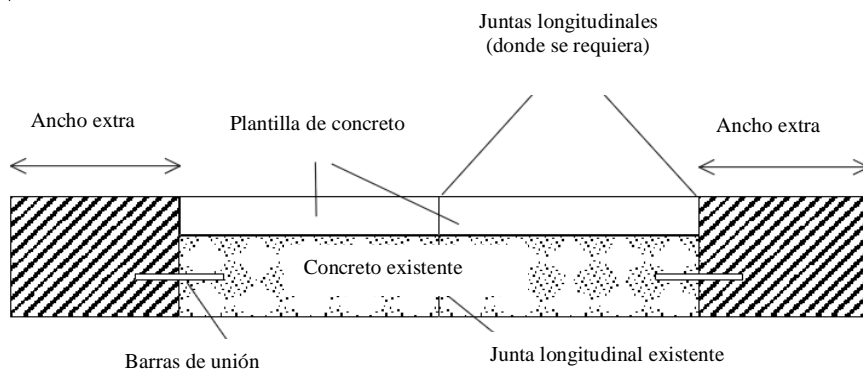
Refuerzo de un pavimento de concreto hidráulico con ampliación.
